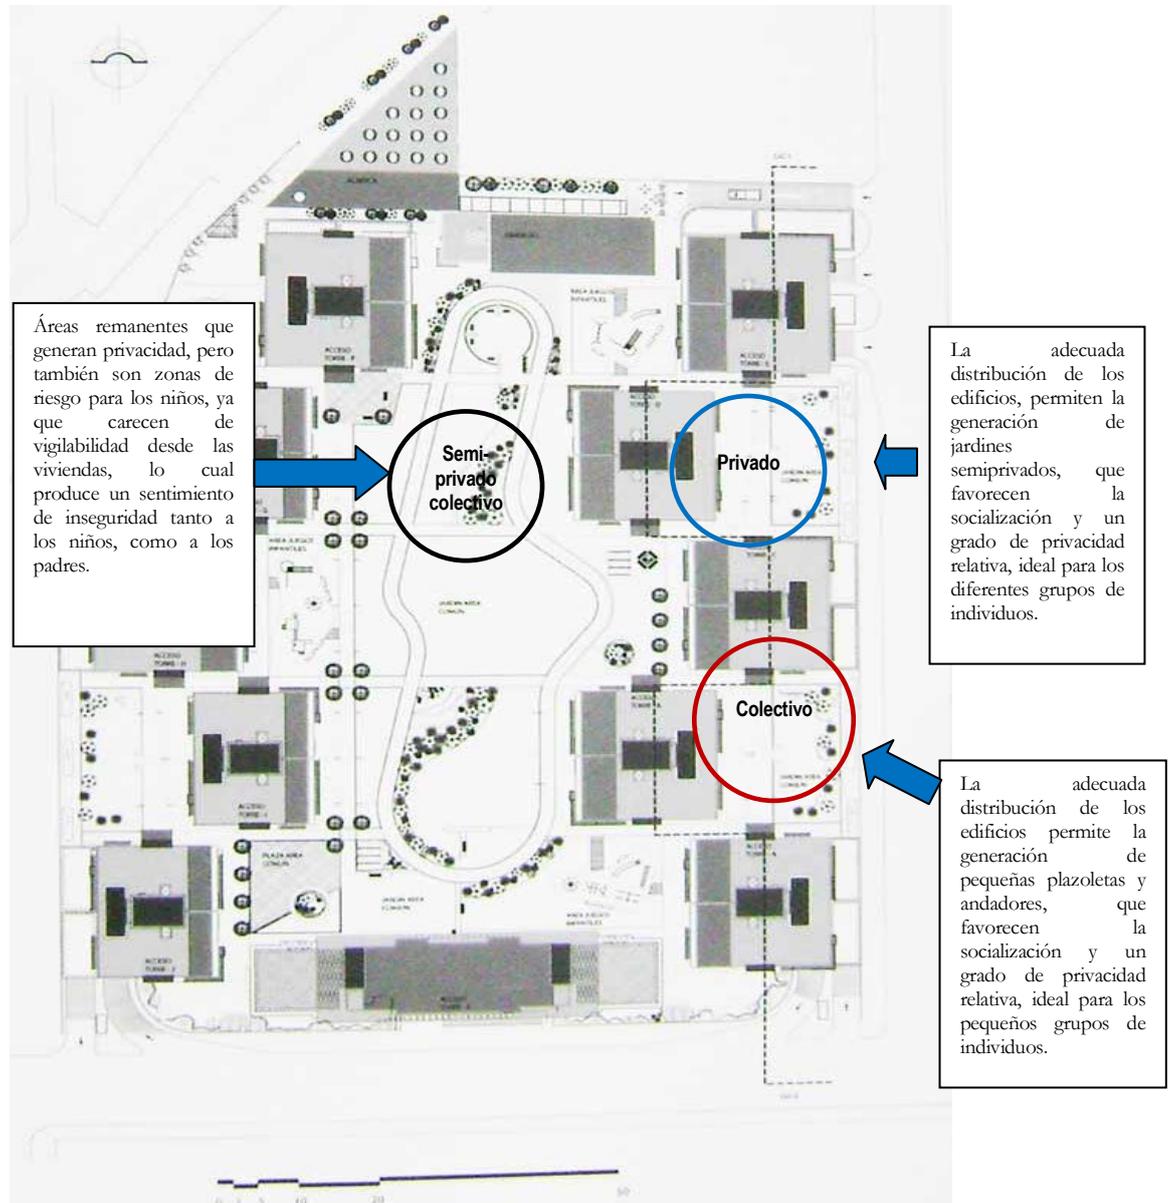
Planta de conjunto. Tres Lagos. Plano realizado por MIGDAL ARQUITECTOS (2004). Esquema de autoría propia.
